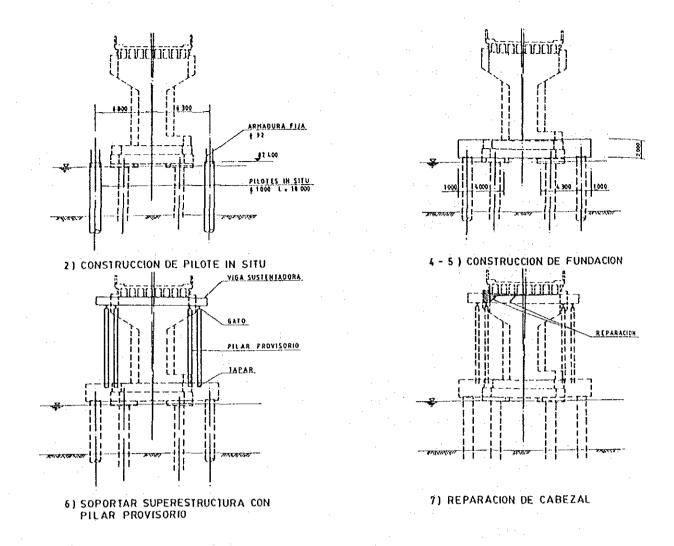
REFUERZO DE LA INFRAESTRUCTURA MEDIANTE PILOTES VACIADOS EN SITIO
